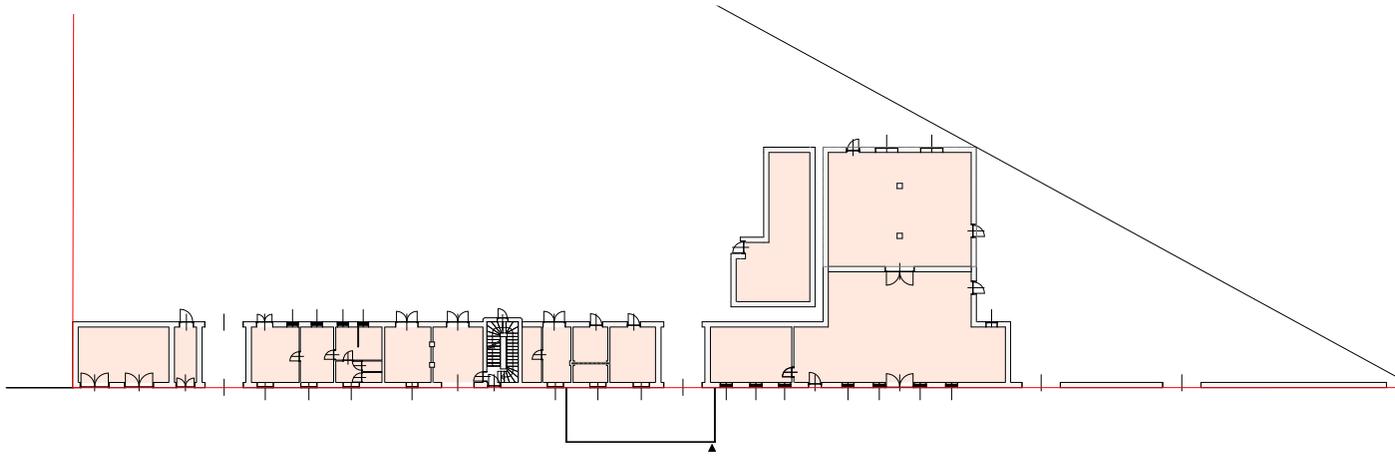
Studie Bestand und Vorentwurf: Grundriss
